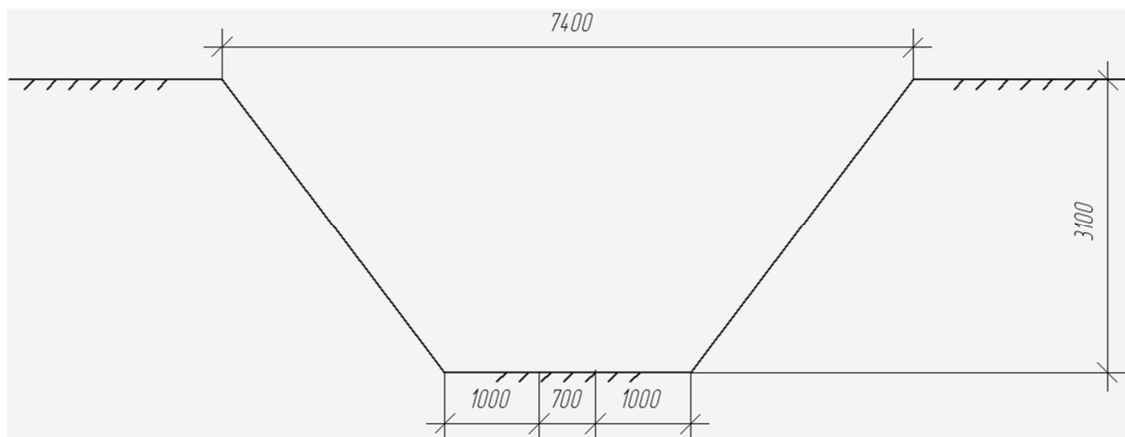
Схема до розрахунку об'ємів робіт по влаштуванню фундаментів з набивних паль
